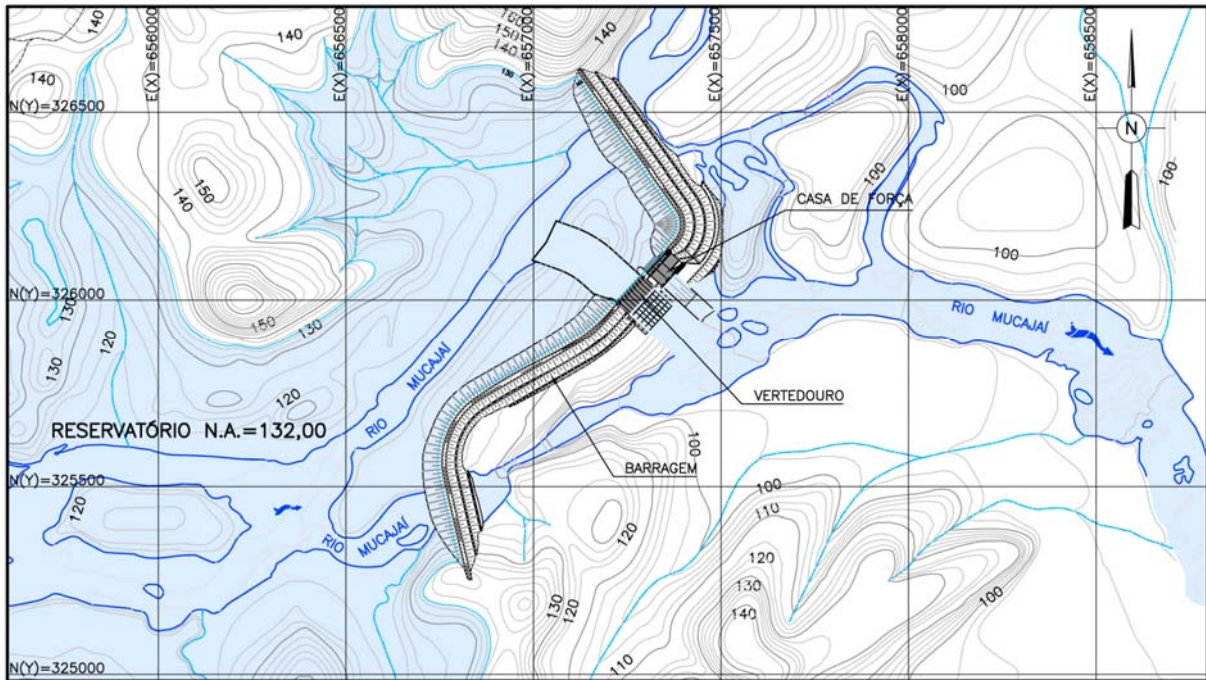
Arranjo Geral do AHE Paredão - Planta
